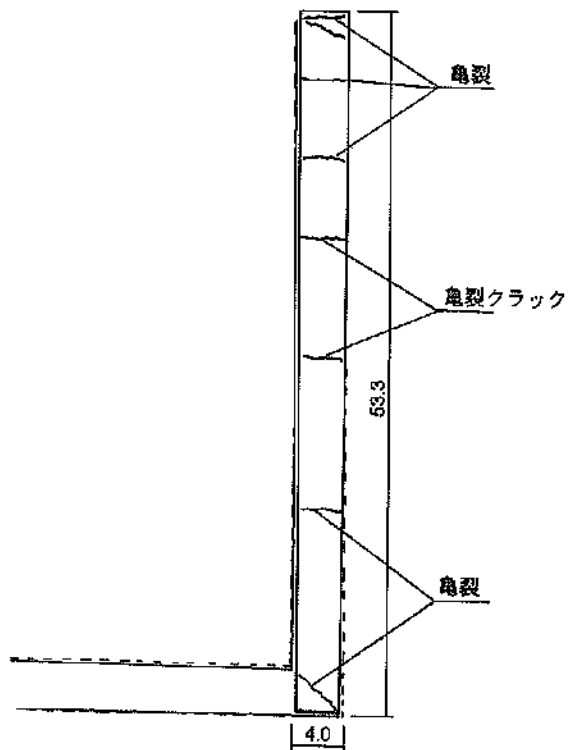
被災状況平面図 (霧多布港：⑧船溜地区臨港道路)
